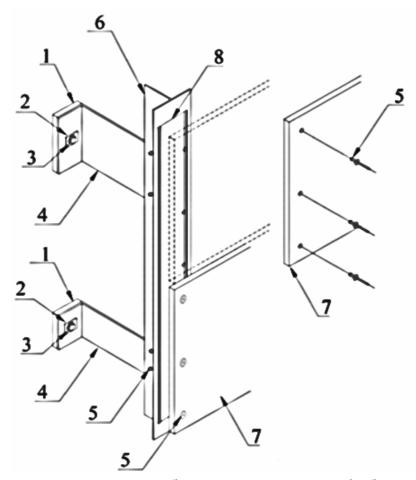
Схема установки облицовочных плит из фиброцемента 1 — терморазрыв; 2 — шайба; 3 — анкер; 4 — кронштейн; 5 — заклепка вытяжная (винт); 6 — направляющая; 7 — облицовочная плита; 8 — уплотнительная лента
